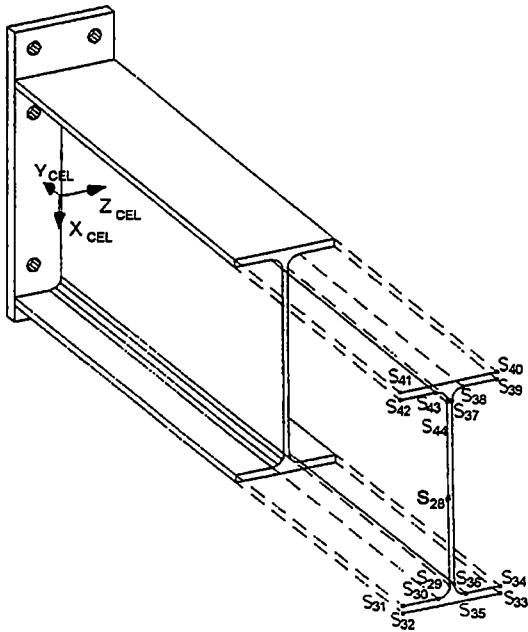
Biegesteifer Stirnplattenstoß, Schweißverbindung
